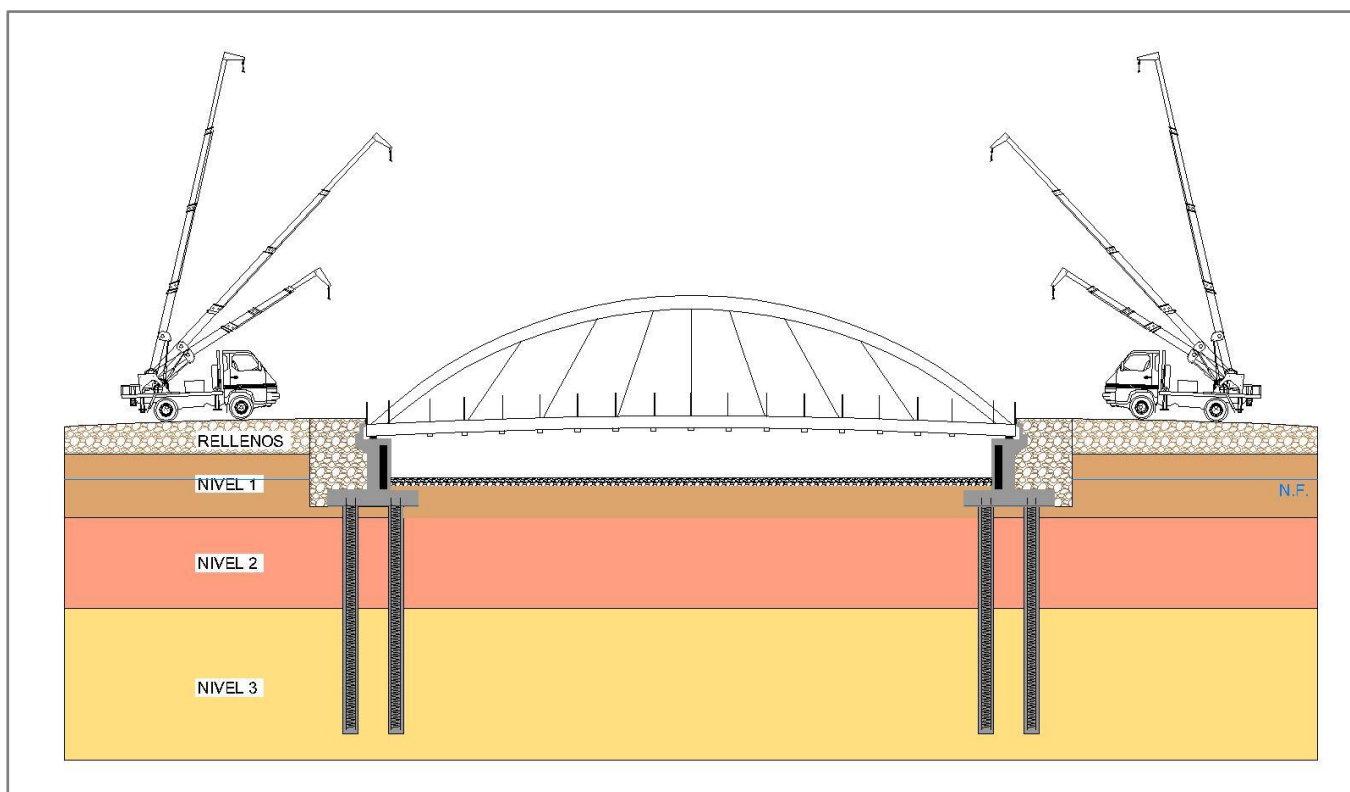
Colocación chapa grecada y soldadura montantes barandillas.
